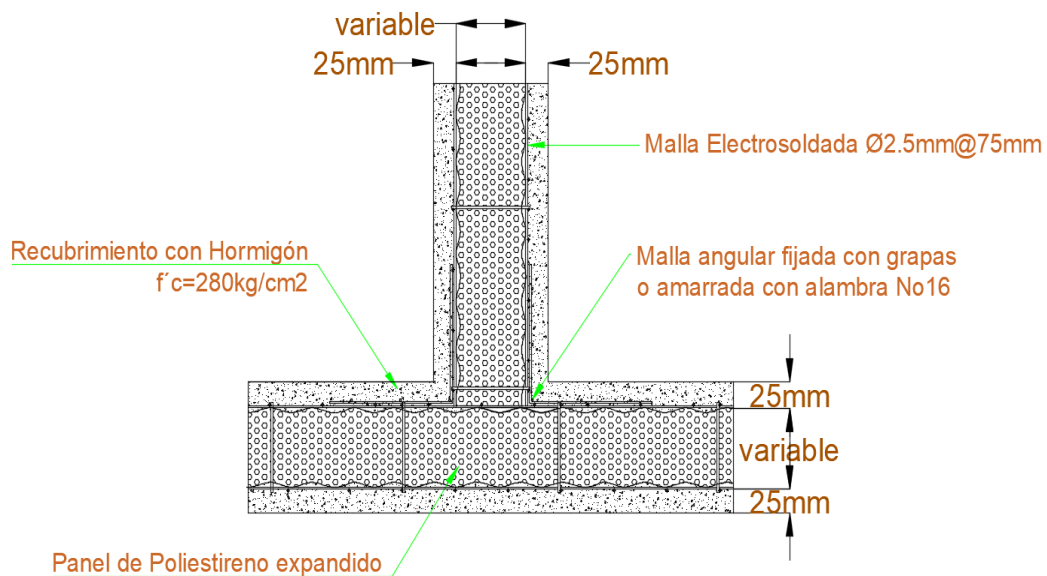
Detalle unión paneles con muros perpendiculares (PLANTA)
